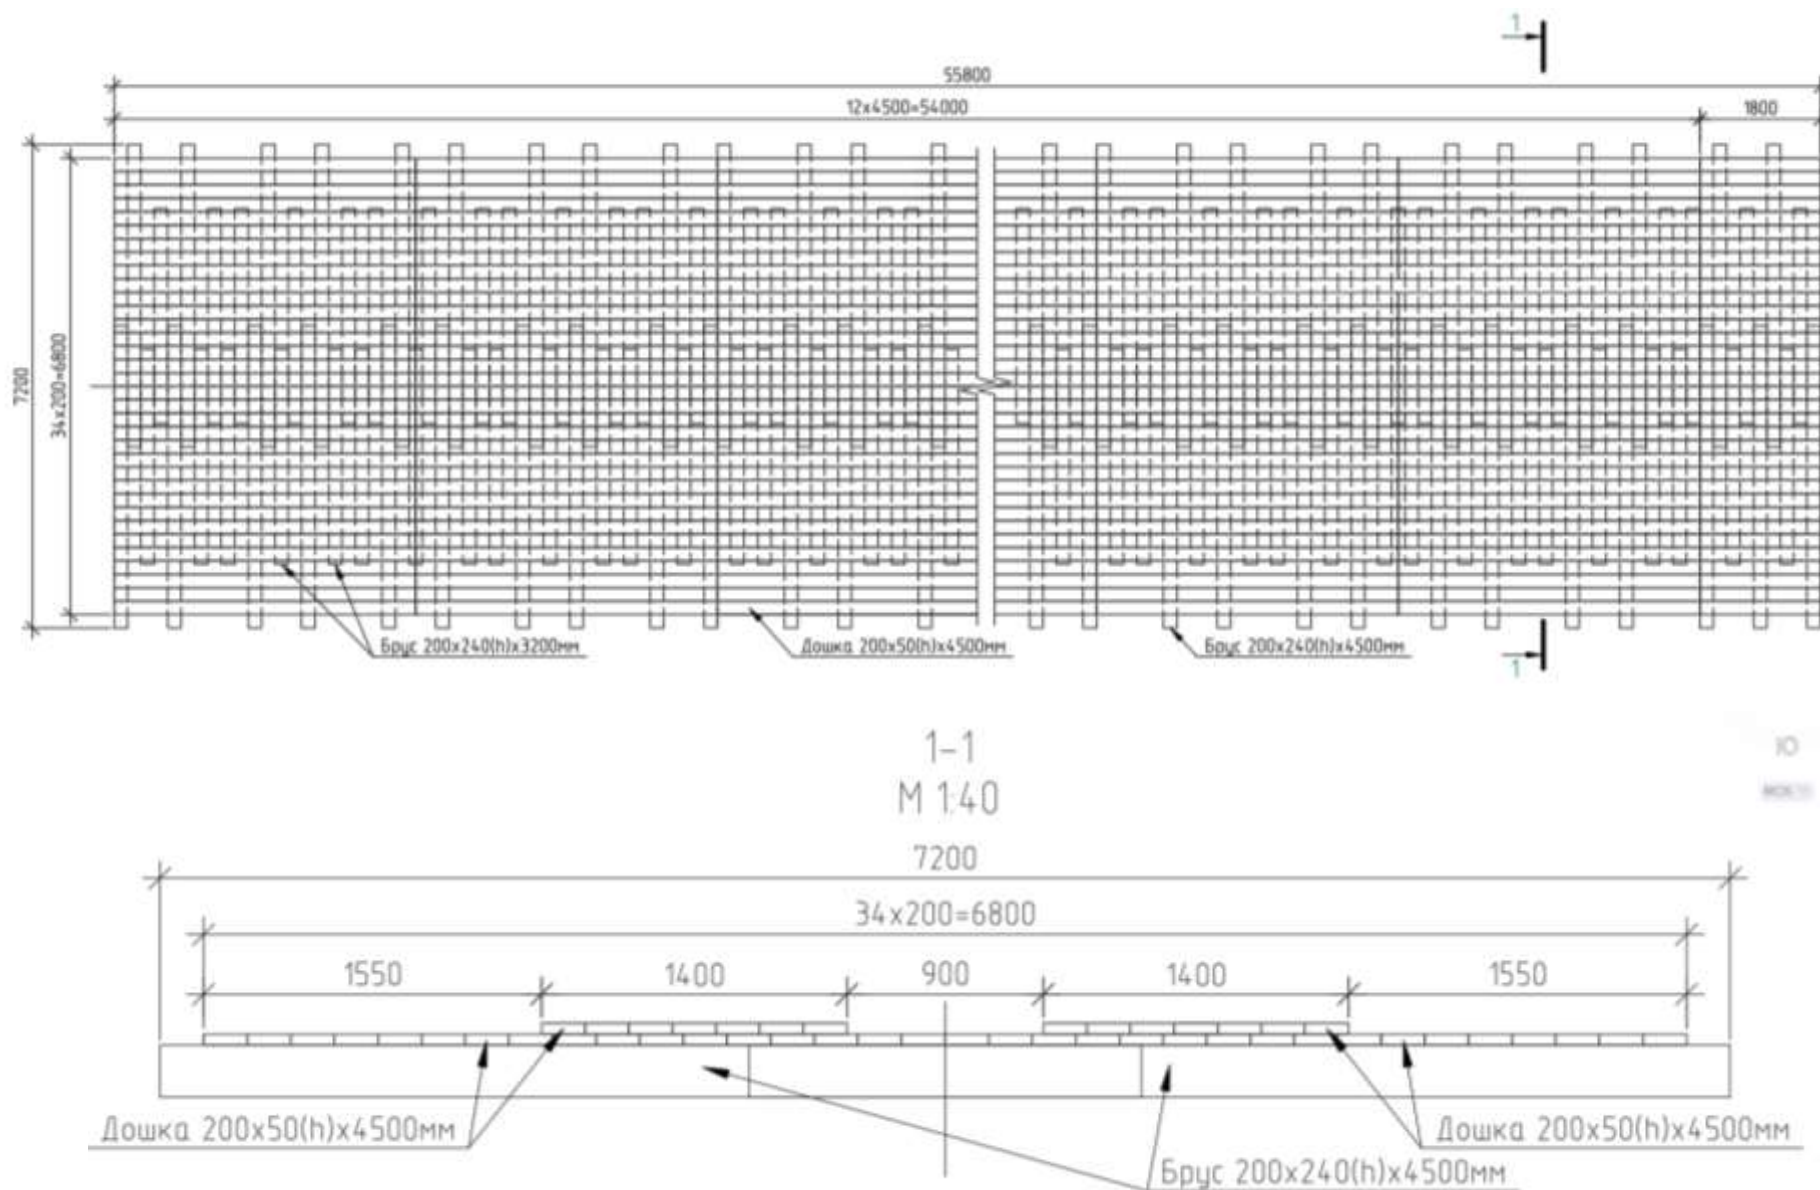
Схема розкладки дошок настилу мосту.
